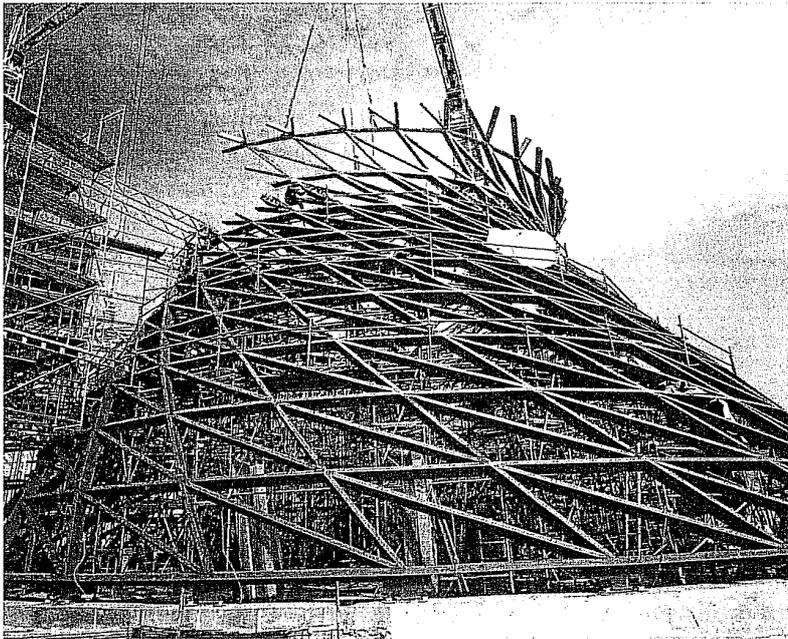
Detailansicht der Montage Kegel (© Buck Fotodesign, München)
